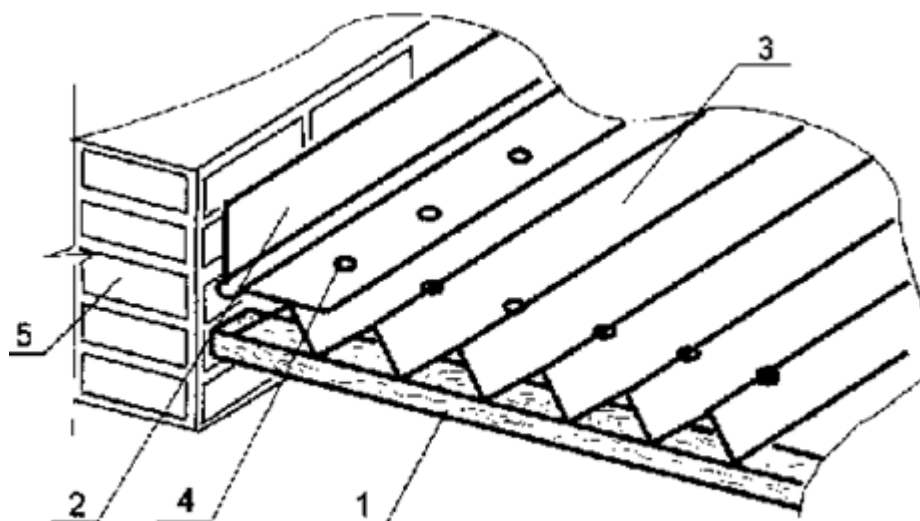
Узел бокового стыка кровли с вертикальной стеной
